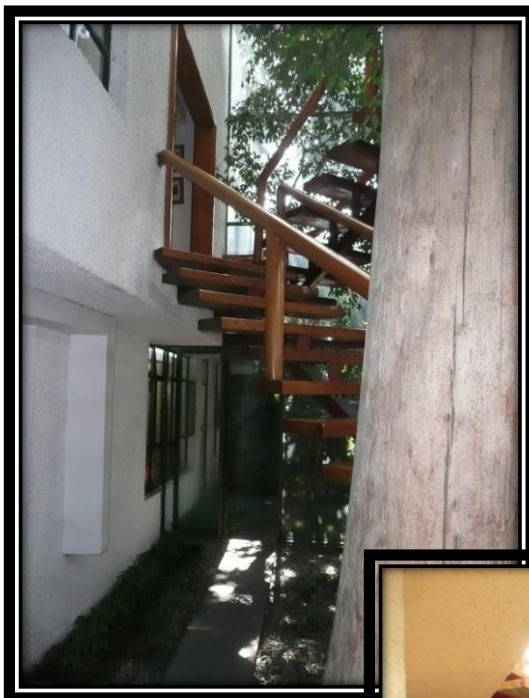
y 313. Retiro de tronco decorativo y colocación de un jardín debajo de escalera principal, así como colocación de piso de concreto lavado para accesos a archivo y oficinas en planta baja de la casa. Autoría propia (2012)
